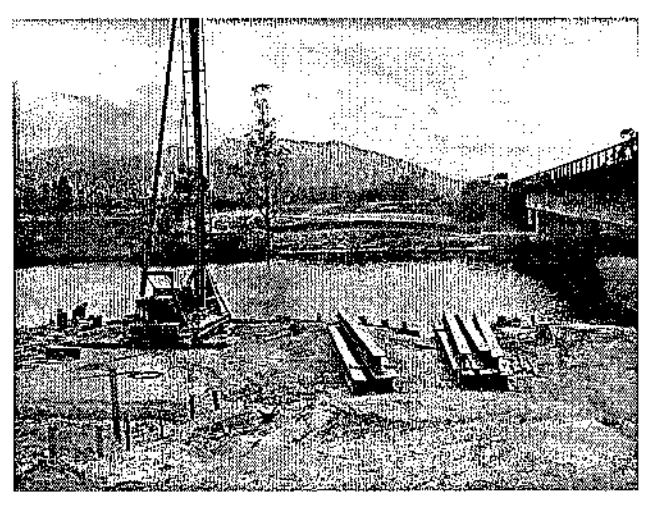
Ponte sobre o Rio da Madre, divisa dos Lotes 22 e 23/SC
